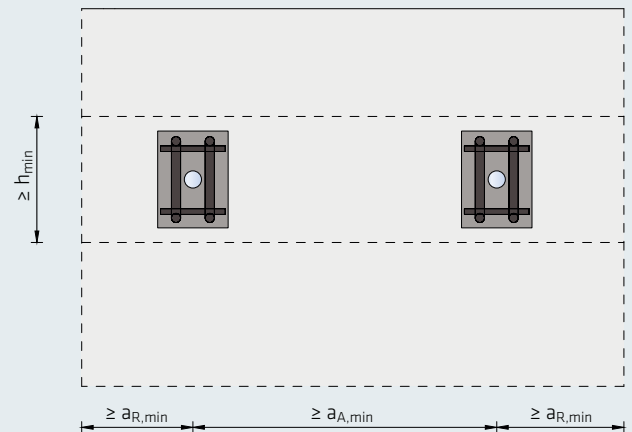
Definition Abmessungen Anschluss Platte - Wand
